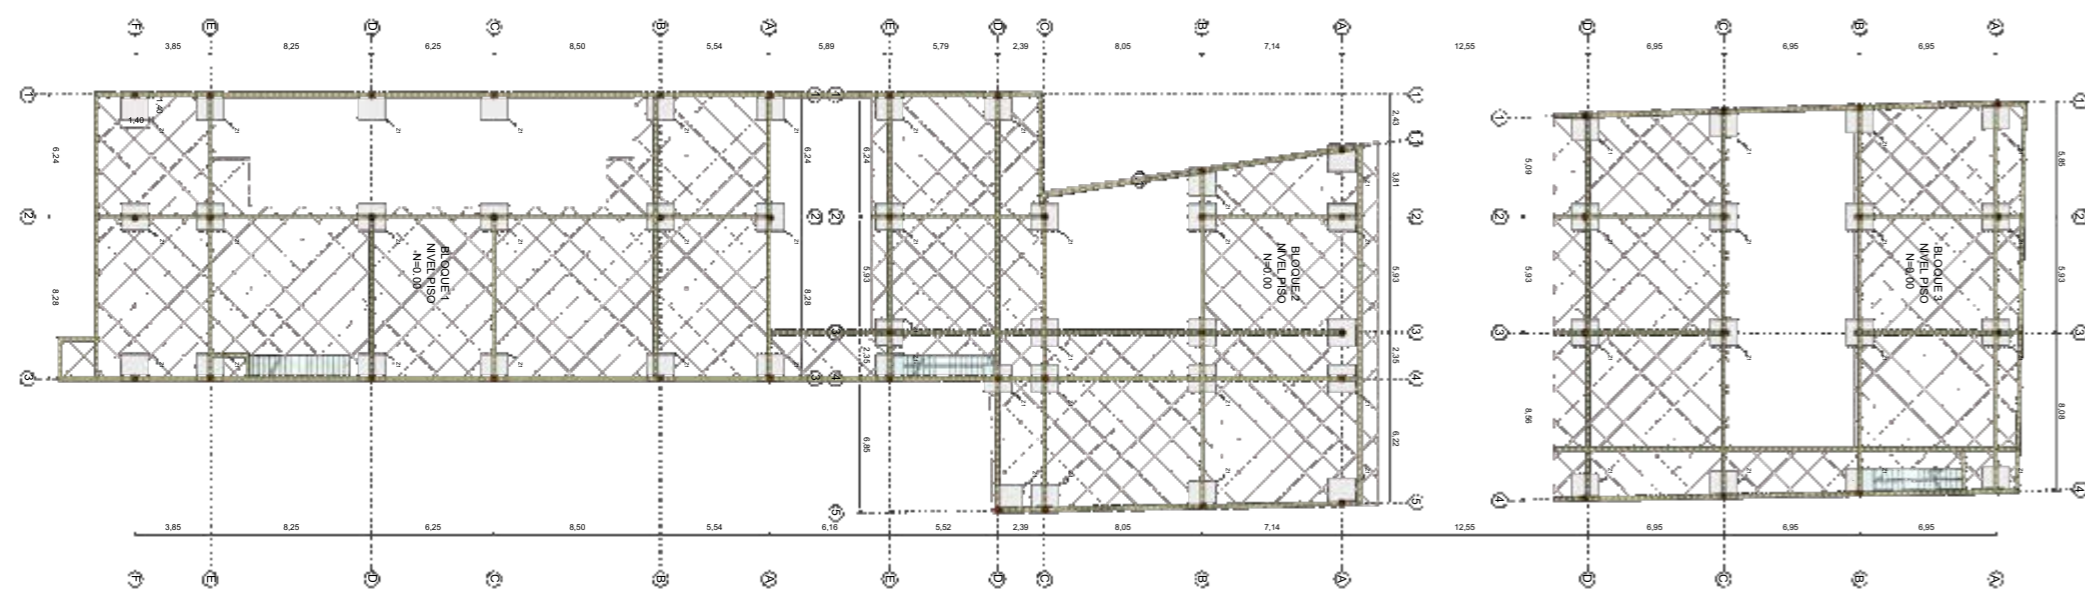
Plano estructural - planta baja del proyecto. Nota. Elaboración propia
